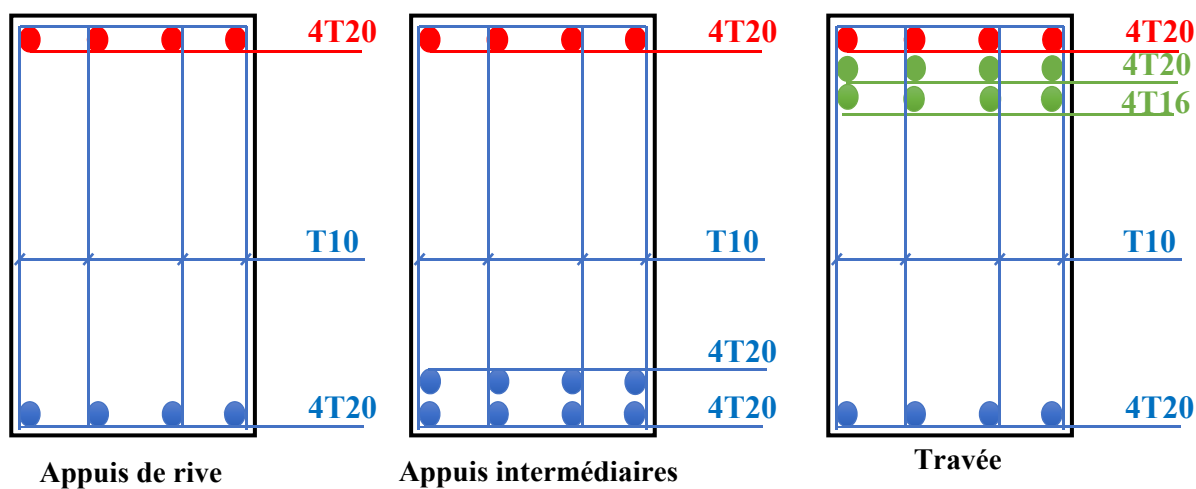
Ferrailage de la poutre de libage (sens Transversale)
